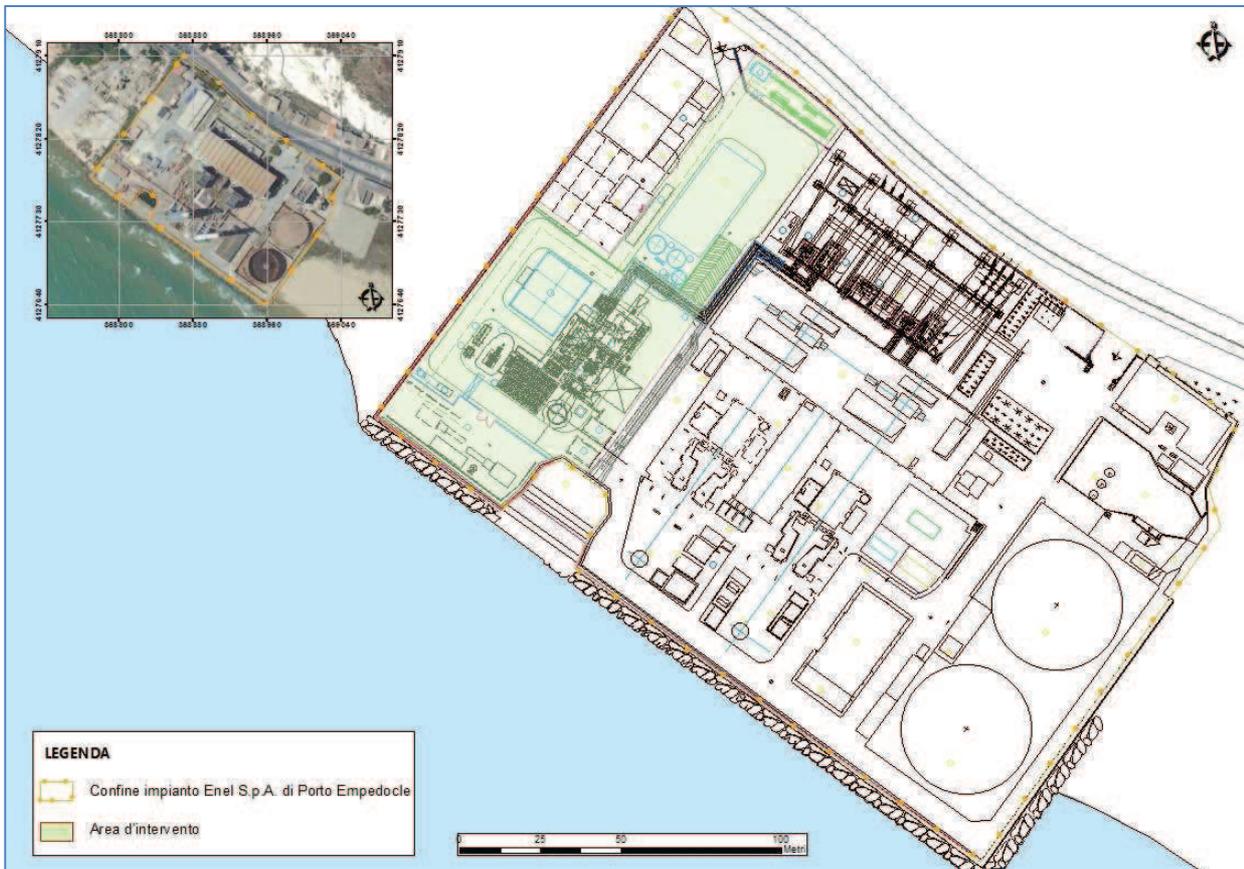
Planimetria d'impianto: ubicazione dell'area d'intervento e sistemazione nuove apparecchiature.
